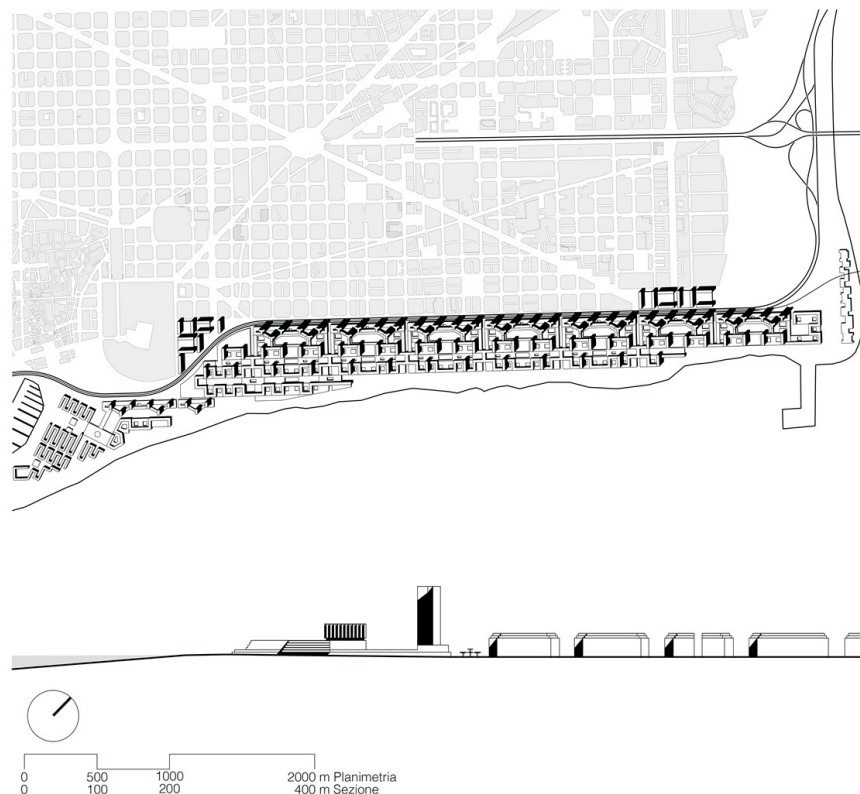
Plan de Urbanización Barrio Sur. Fuente: elaboración dell'autore.
